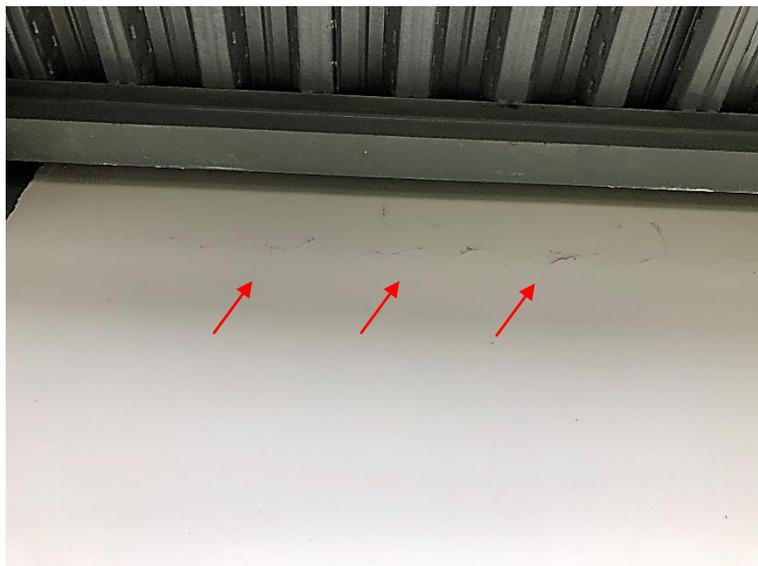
Trincas horizontais em alvenaria na sala de ginástica
